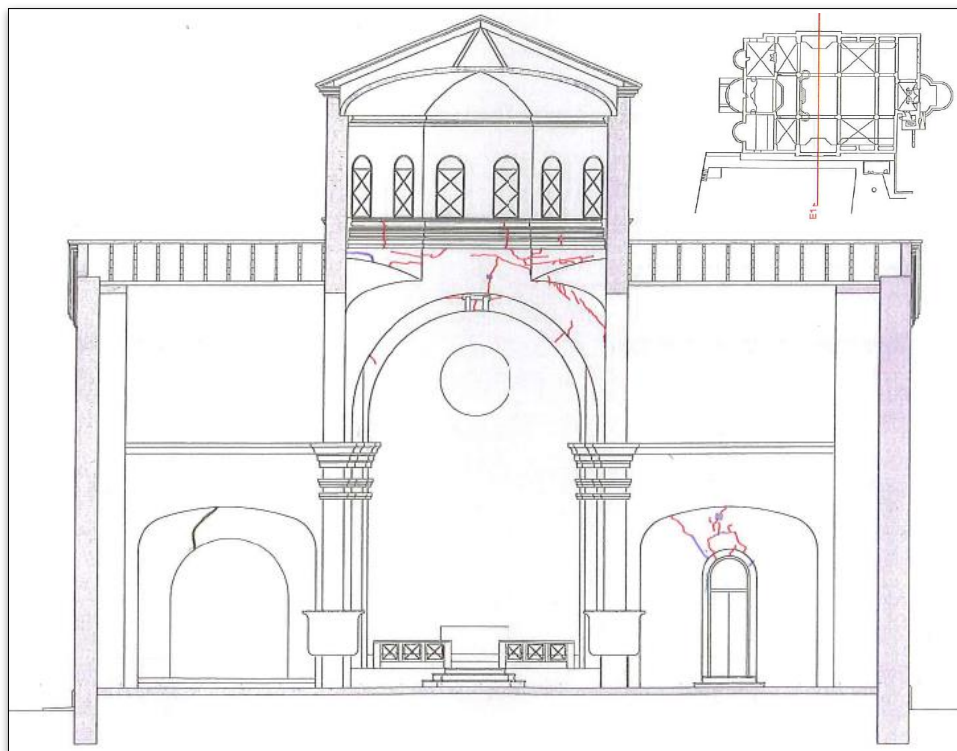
Grietas sección transversal central (plano PAT. 08)
